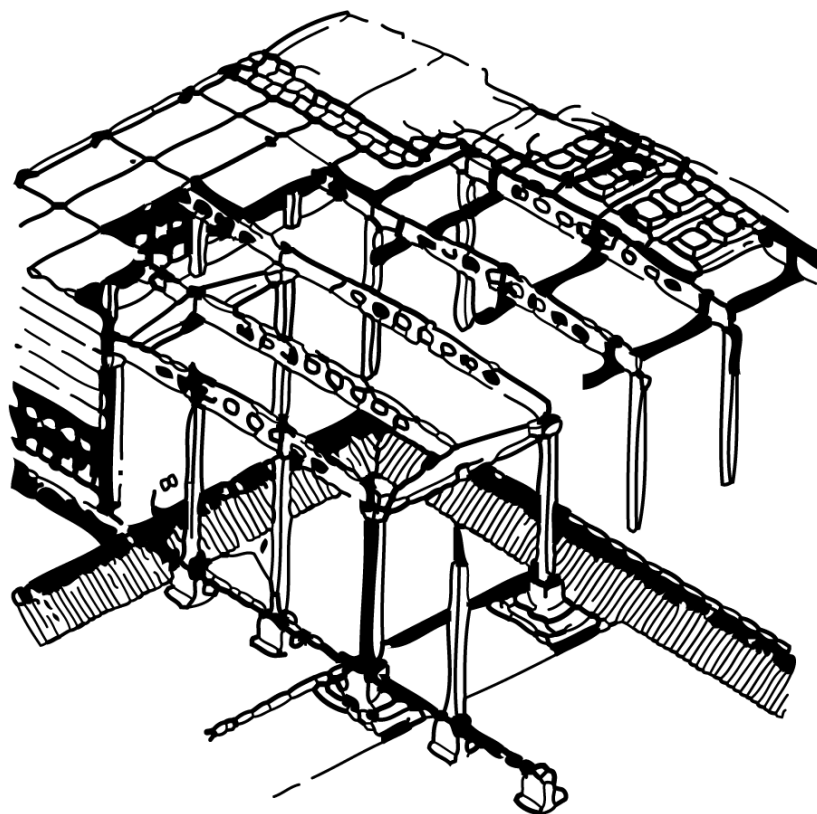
Монтаж перемычек для соединения металлической арматуры зданий.
